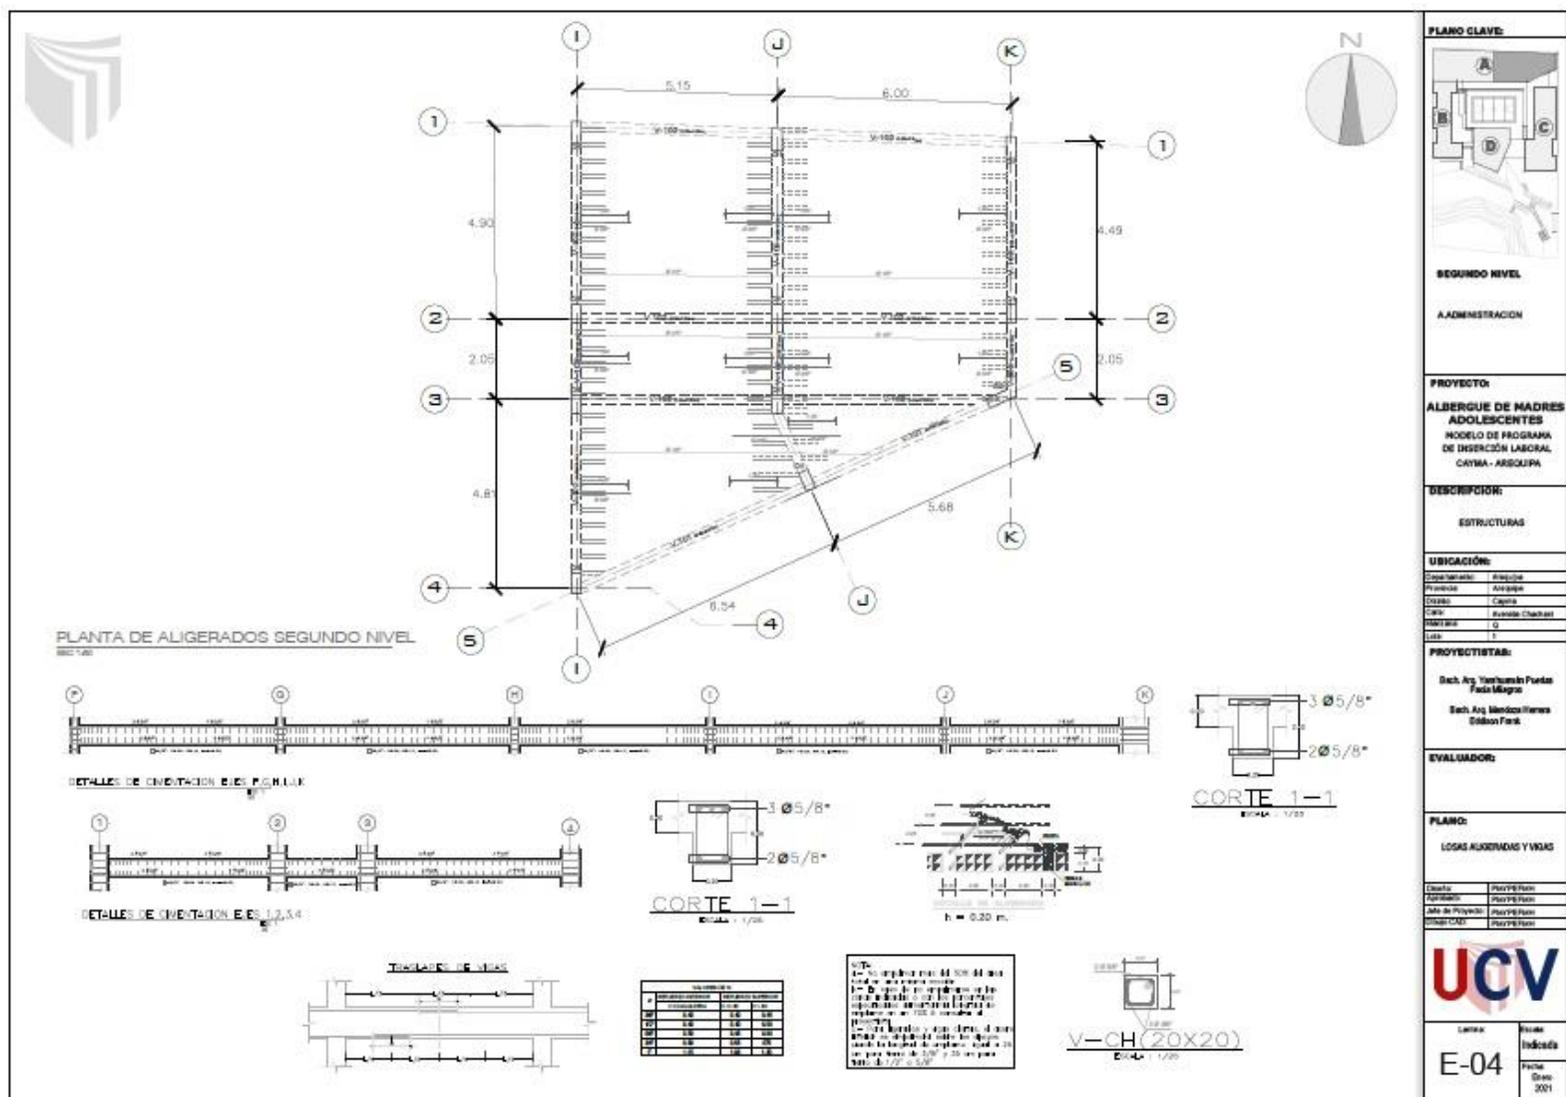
Plano de Estructura de Losa y techos – Sector A – Cuna Jardín E-04.
